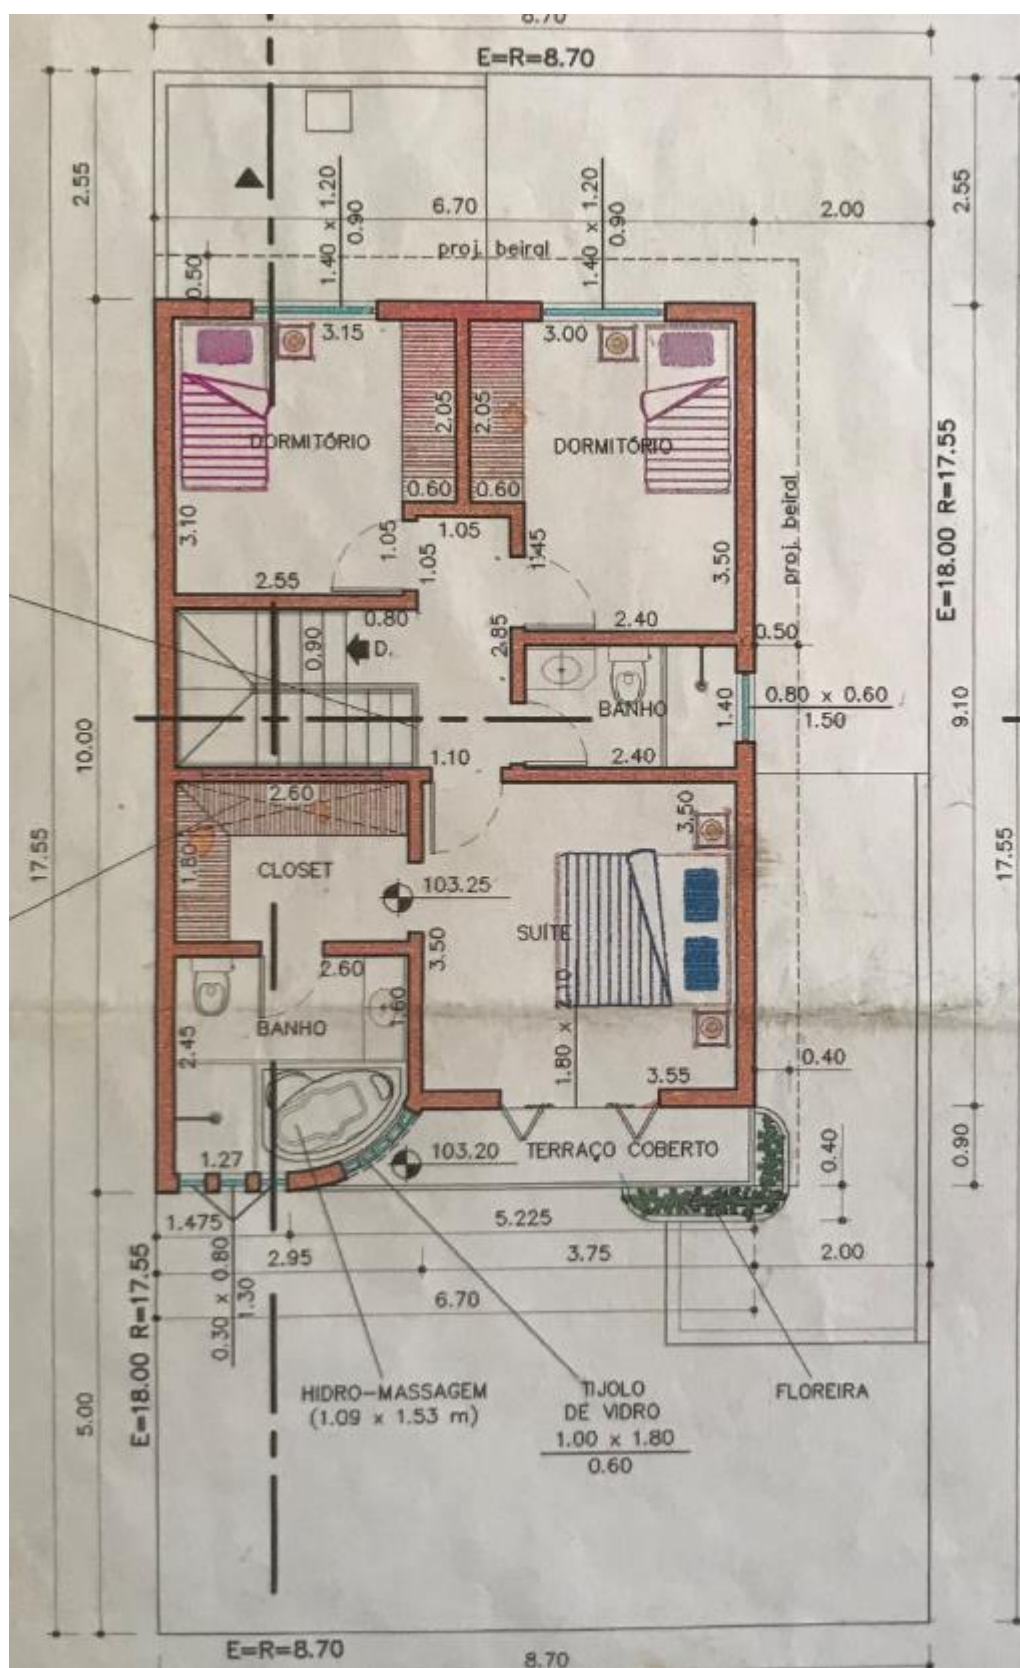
Planta do pavimento superior do imóvel paradigma.
